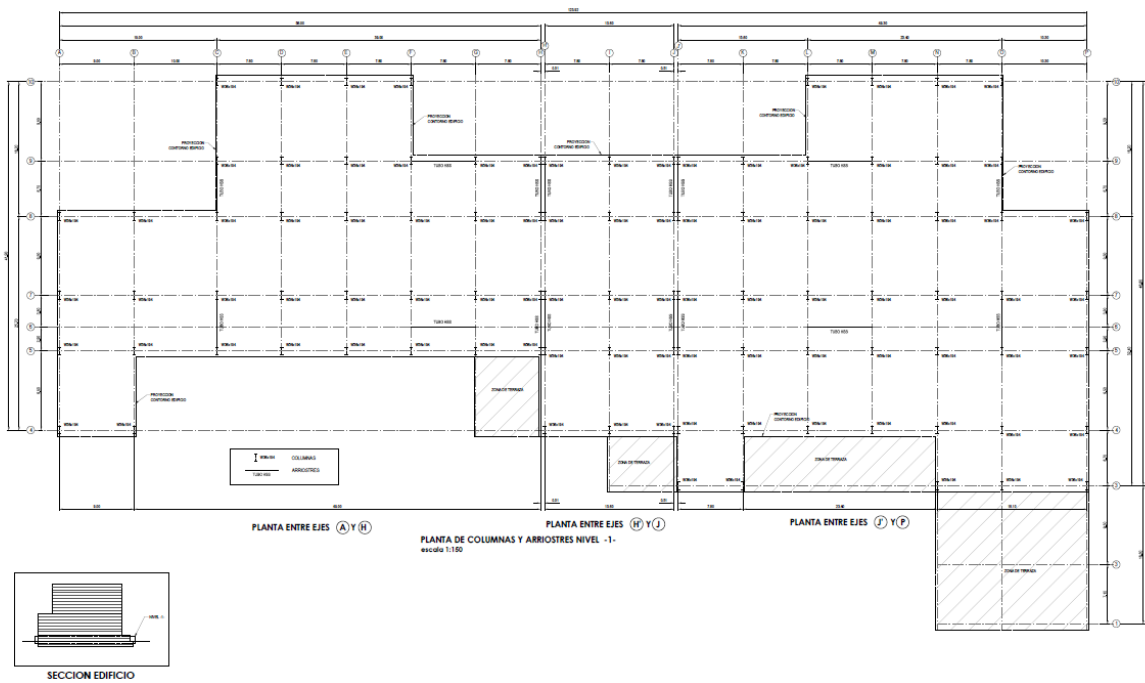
Planta Estructural Columnas, Muros y Arriostres. Nivel 1
